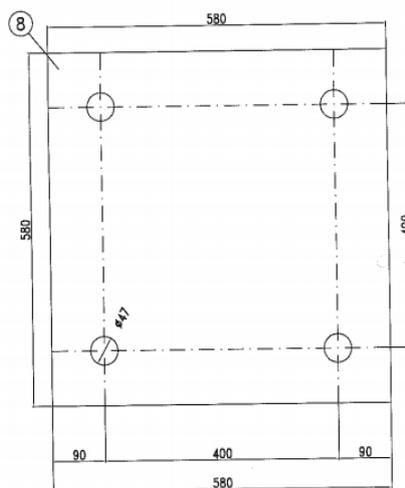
Piastra e disposizione tirafondi LSU18a
